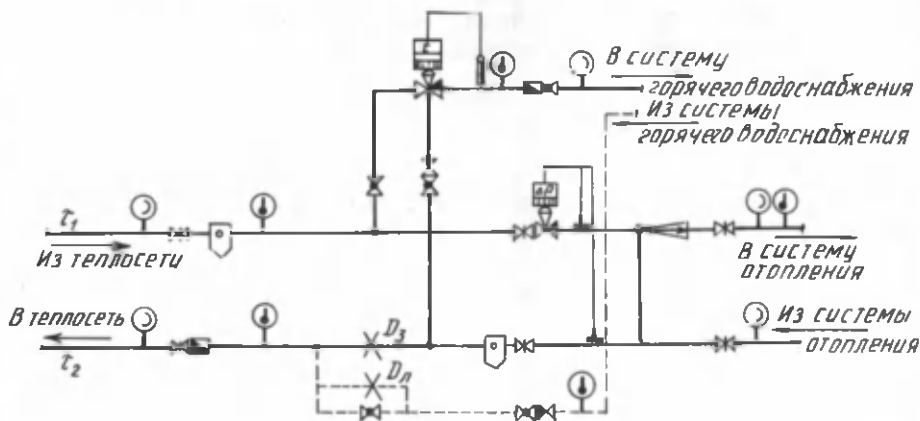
Схема теплового пункта открытой системы теплоснабжения
